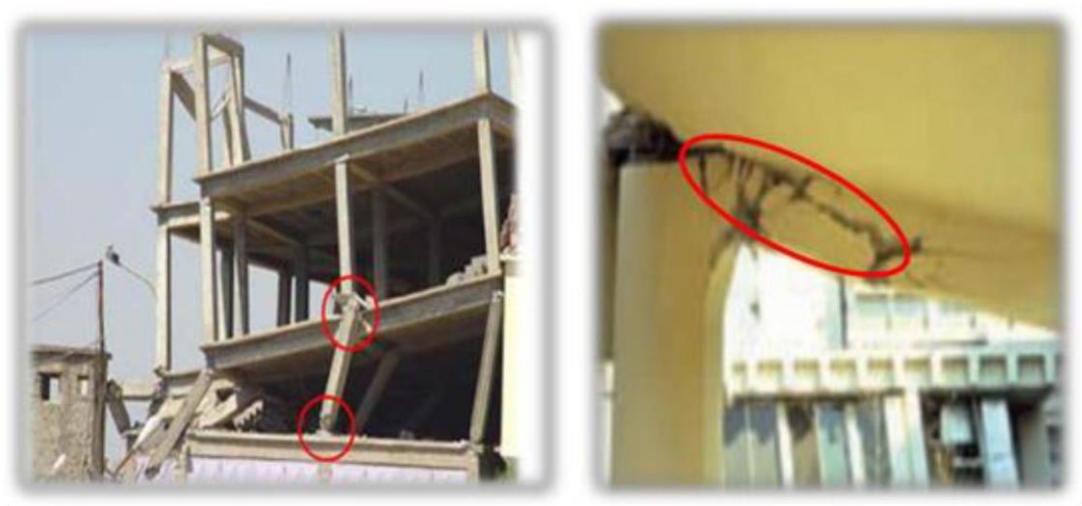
Rotule plastique au niveau des poteaux et des poutres.
